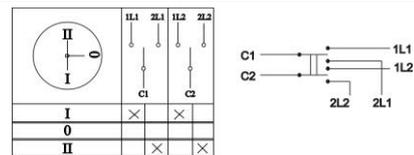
Пакетный переключатель 2-полюсный на 2 направления
